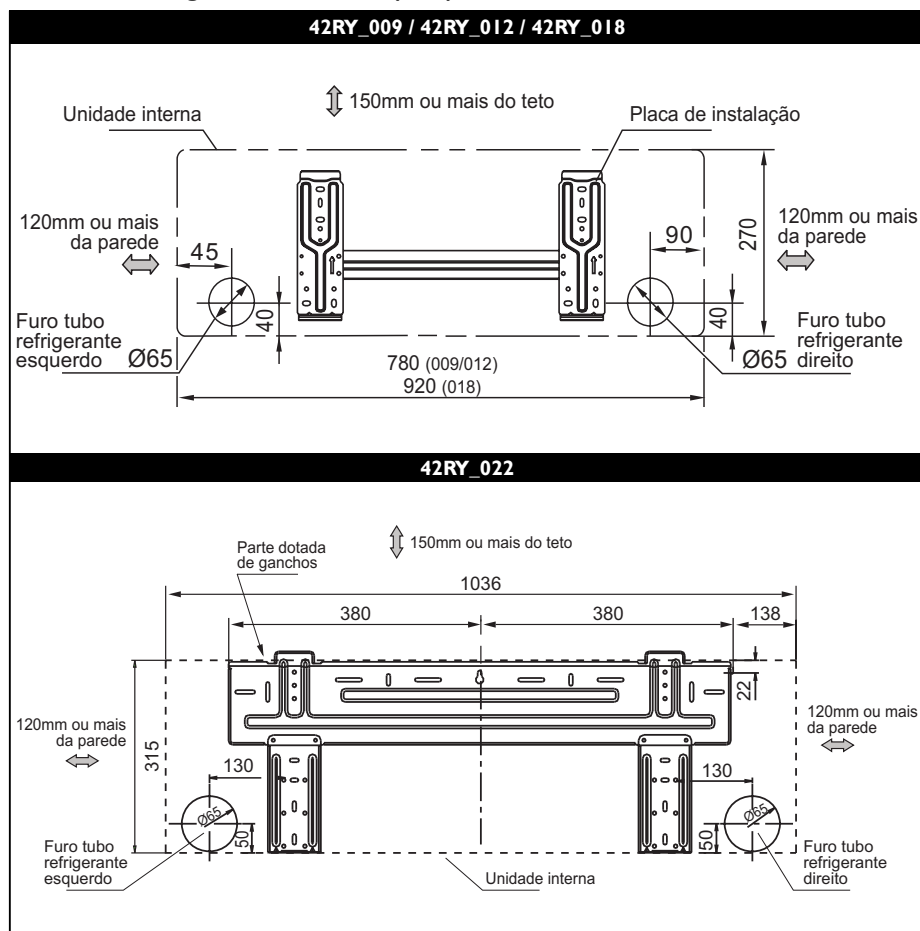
PLACAS DE INSTALAÇÃO / MONTAGEM
